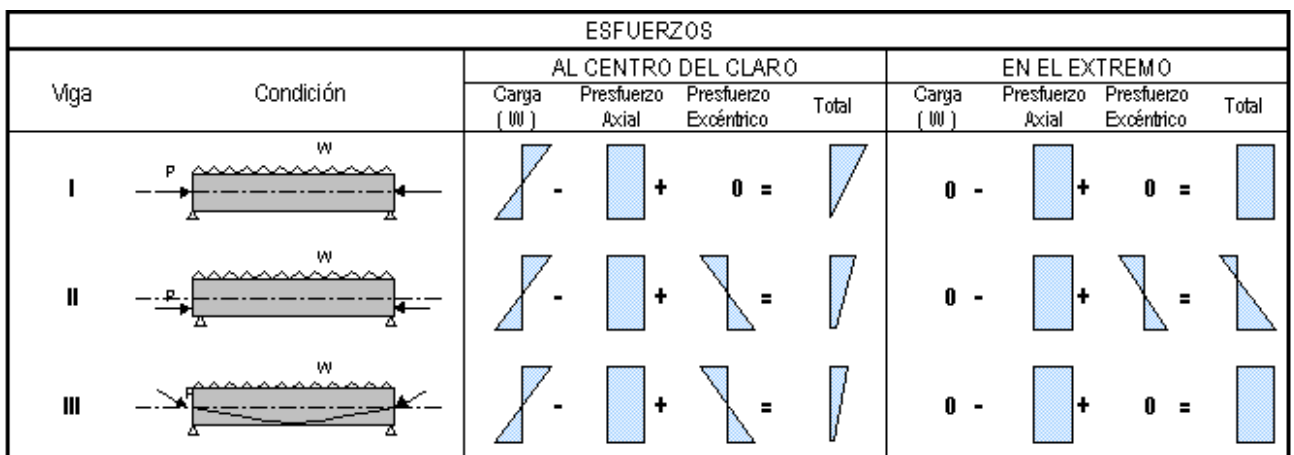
Esfuerzos al centro del claro y en los extremos de vigas simplemente apoyadas con y sin presfuerzo.
